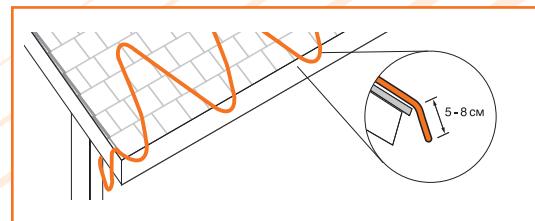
Укладка кабеля по схеме “ капающая петля ”
